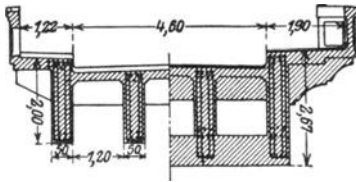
b. Querschnitt durch die Feldmitte; am Auflager.
